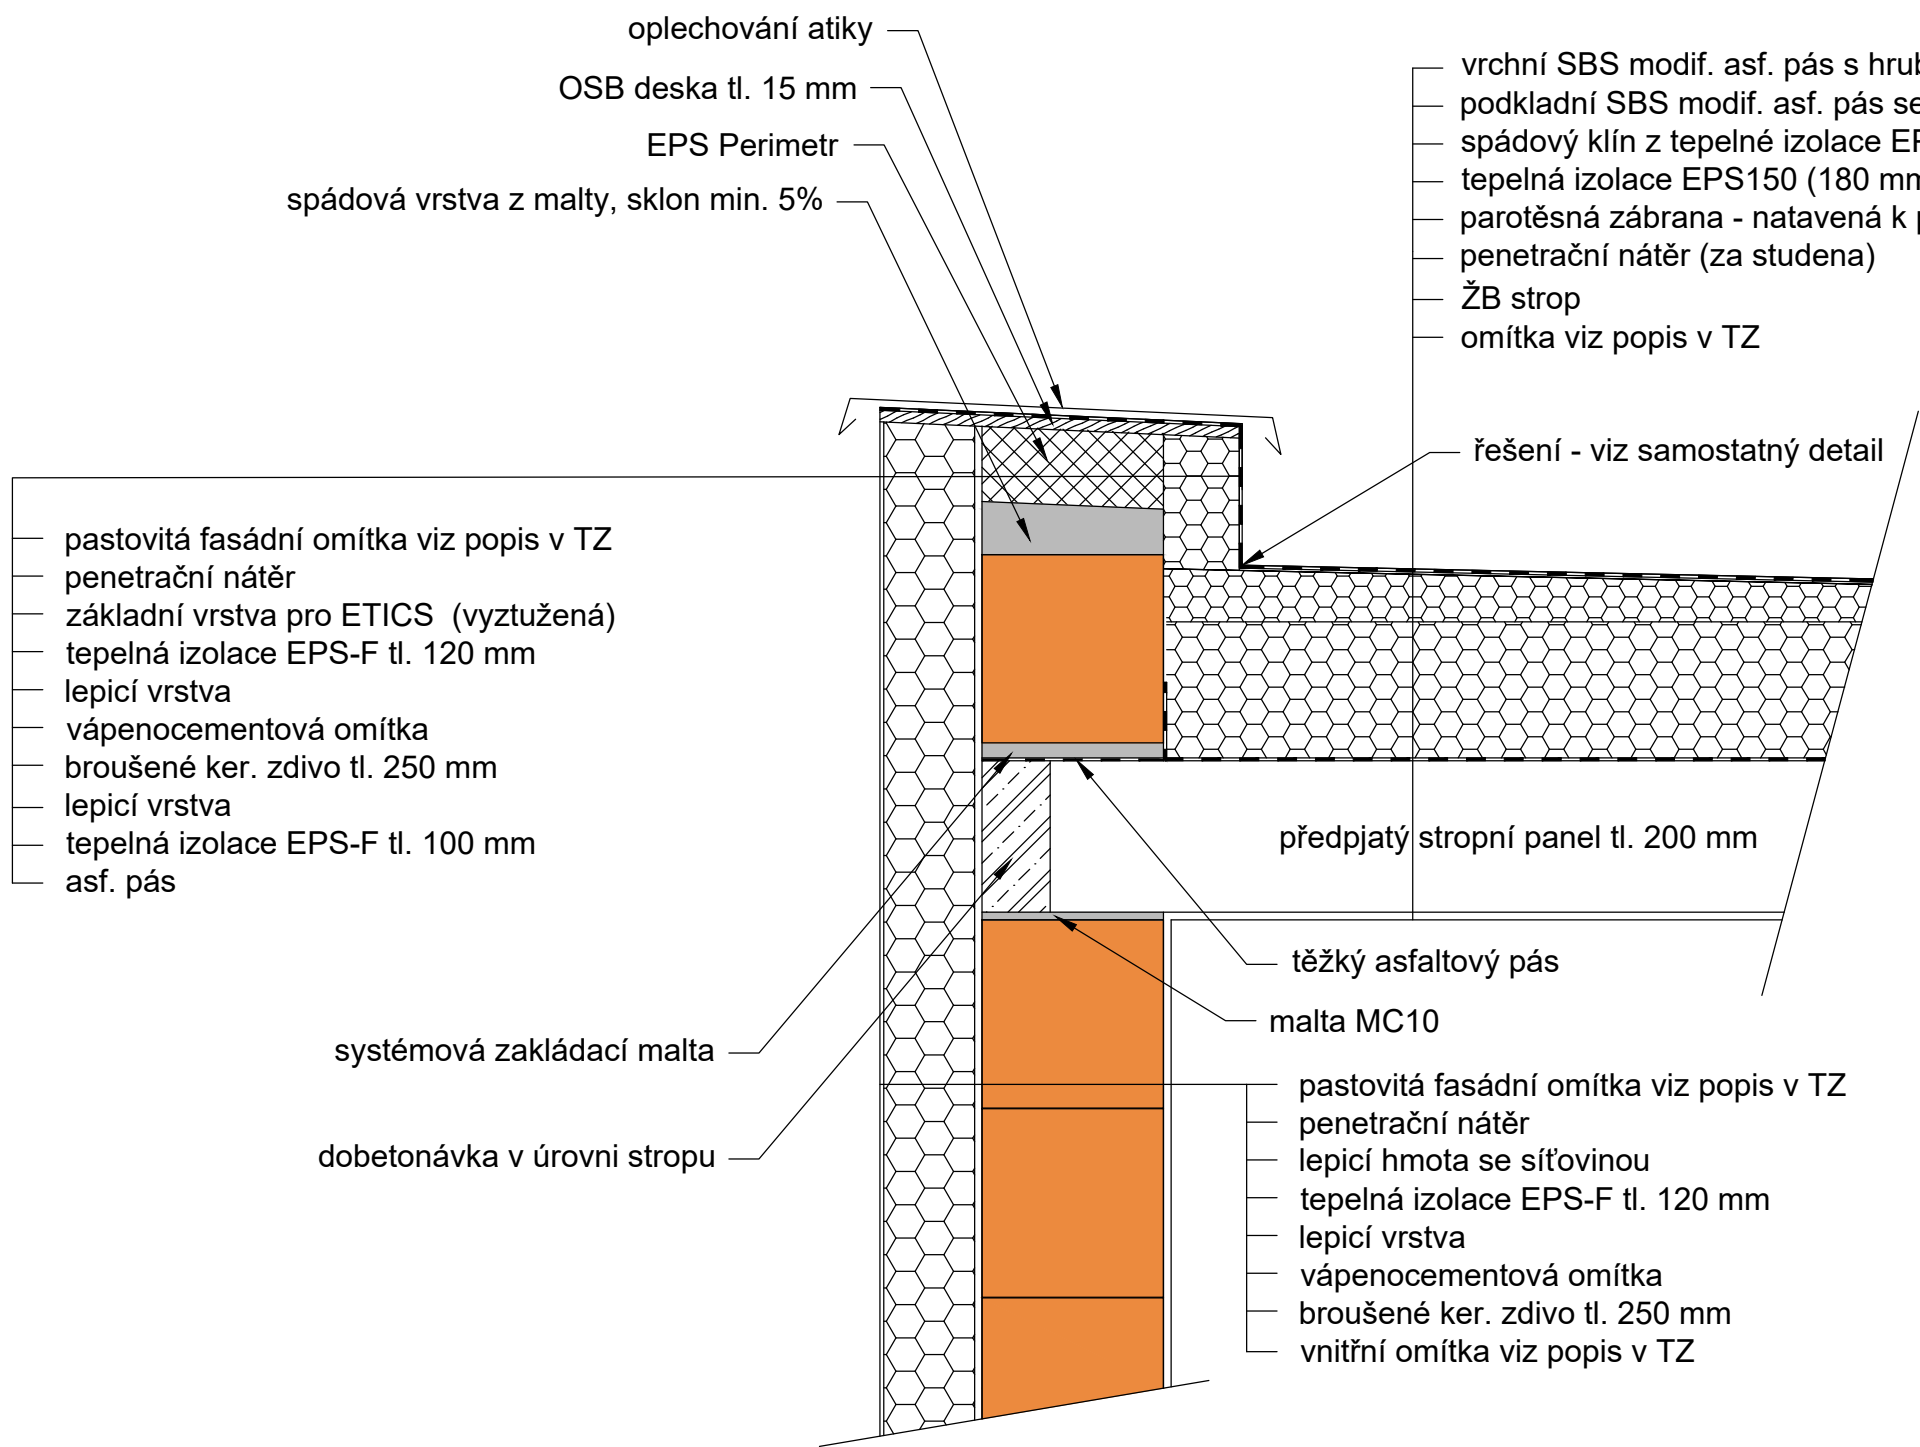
DETAIL ZESÍLENÍ KOUTU ATIKY (PŘECHOD MEZI STŘECHOU A ATIKOU)
